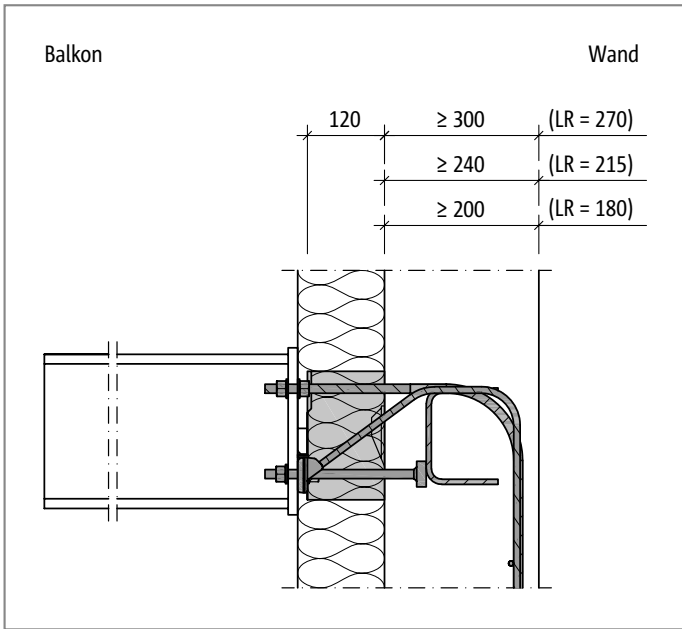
Schöck Isokorb® XT Typ SK-WU: Sonderkonstruktion für Wandanschluss
